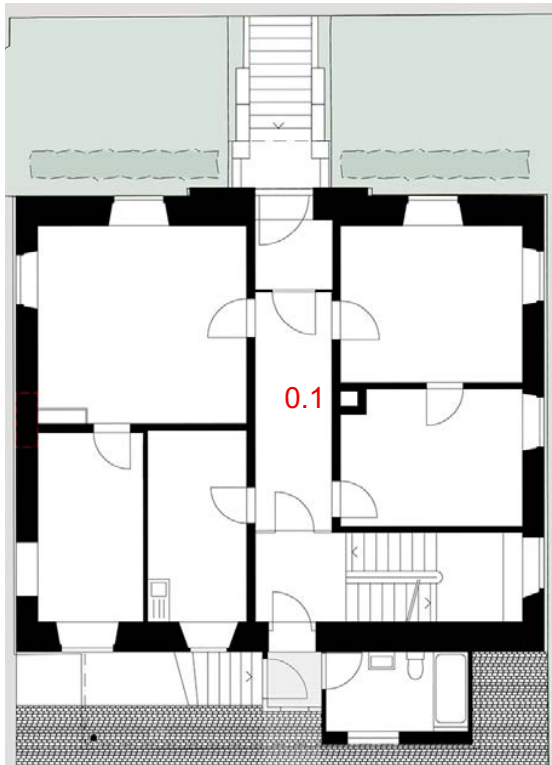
Grundriss EG, Korridor 0.1.
